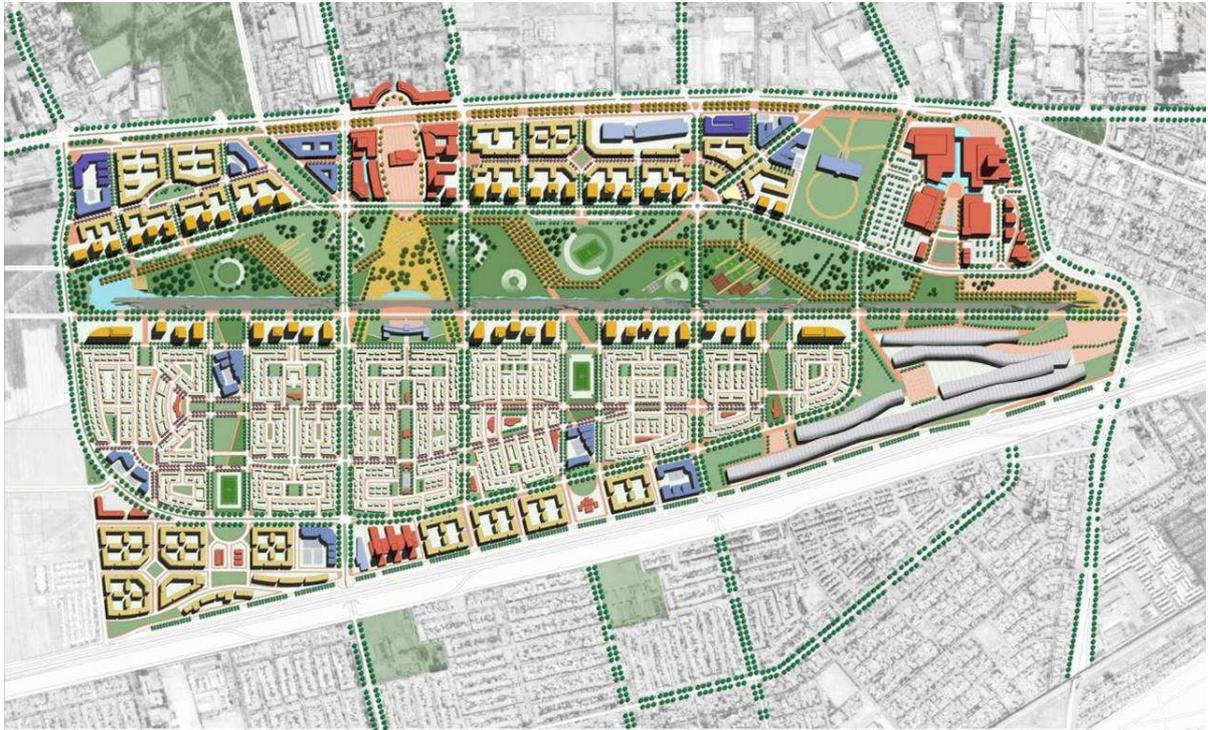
Planta general proyecto Portal Bicentenario.
